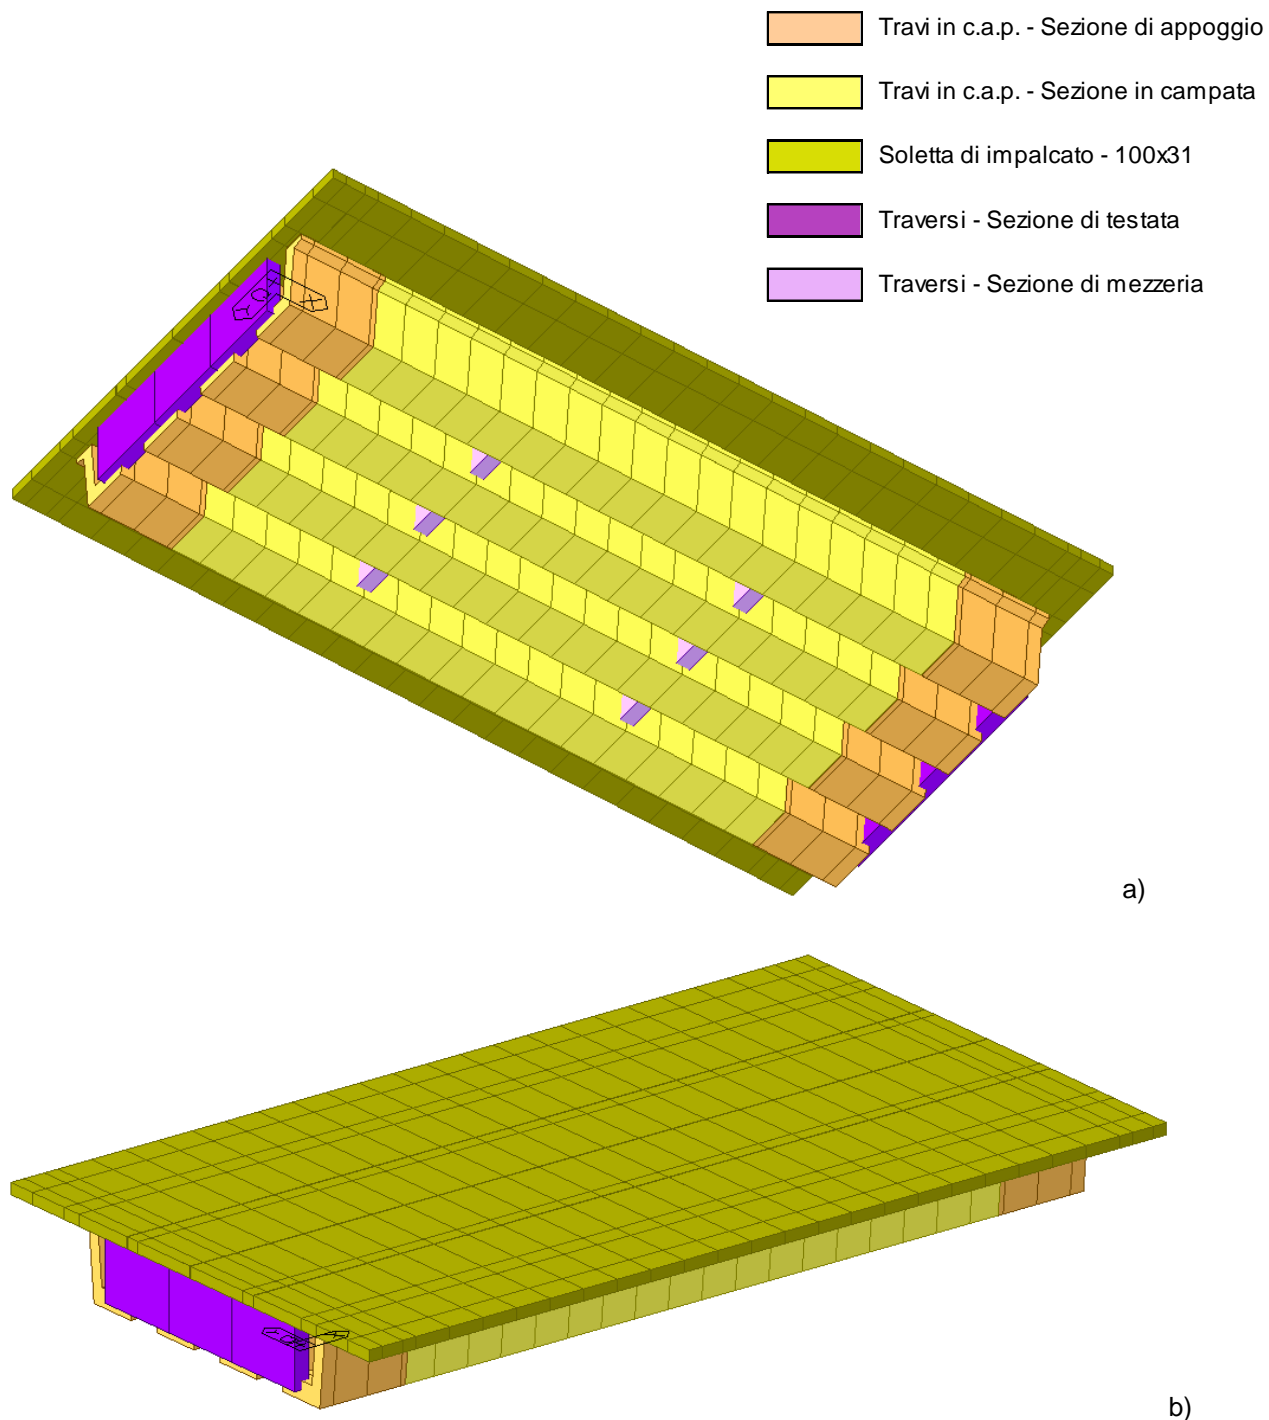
Modellazione tridimensionale agli Elementi Finiti – a) Vista dal basso b) Vista dall'alto
